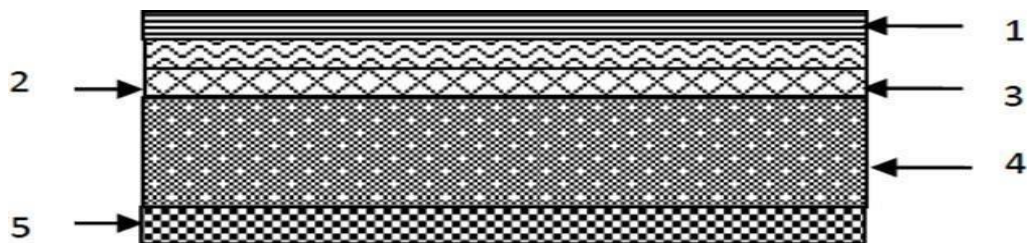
Coup transversal de plancher à dalle pleine (Balcon).
